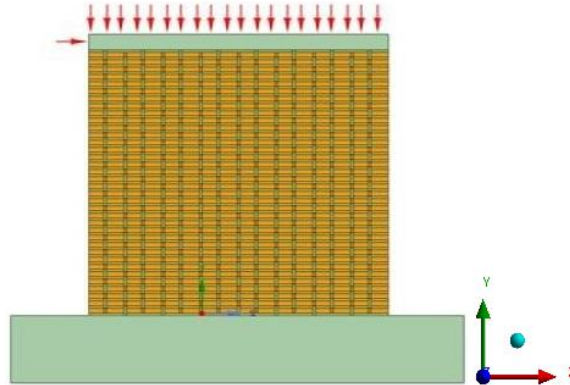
Muro con carga lateral y presión aplicada (Fuente: Elaboración propia)
